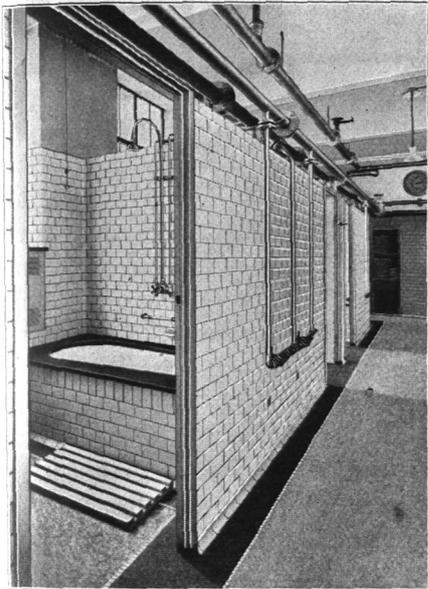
Badeanstalt Hammerbrook, Wannenbad.
